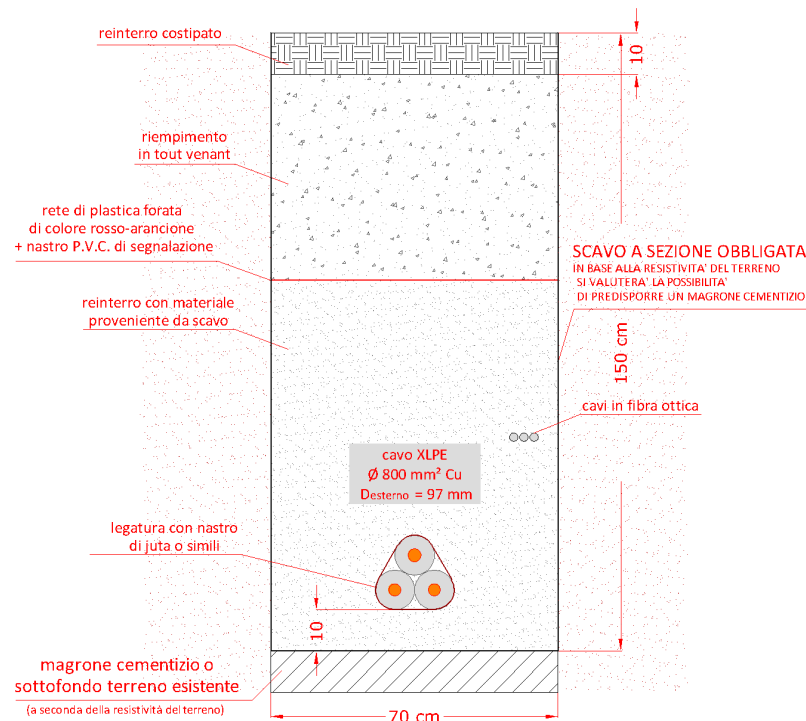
Sezione tipica di posa del tratto di cavidotto terrestre, su terreno naturale
